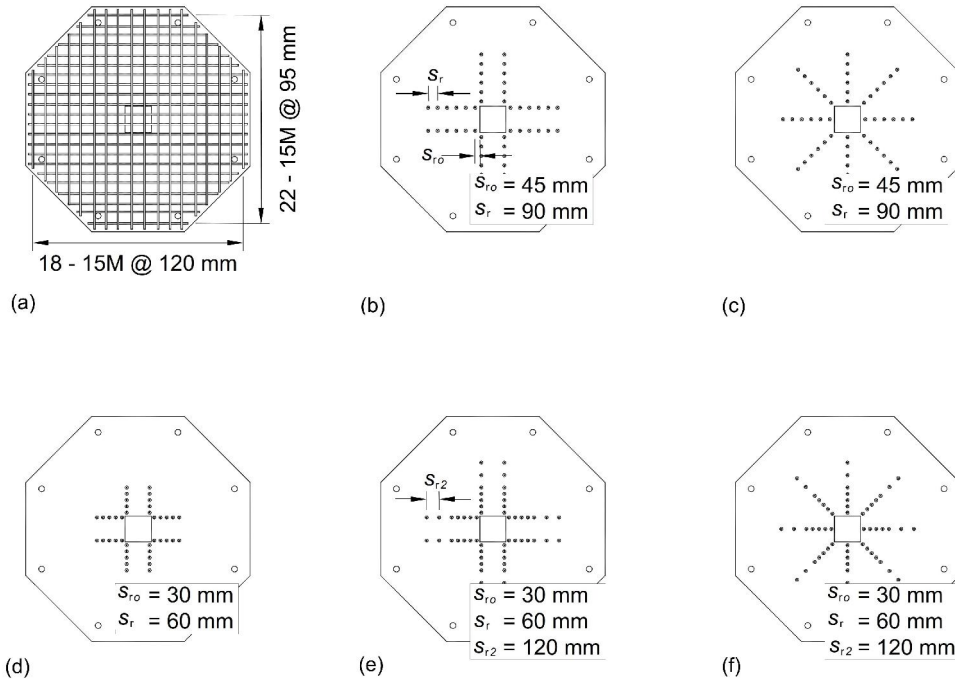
Armadura de flexão e disposição dos "studs": (a) Armadura de flexão das lajes 1 a 6; (b) Disposição dos "studs" na laje 2; (c) Disposição dos "studs" na laje 3; (d) Disposição dos "studs" na laje 4; (e) Disposição dos "studs" na laje 5; (f) Disposição dos "studs" na laje 6 [8].
